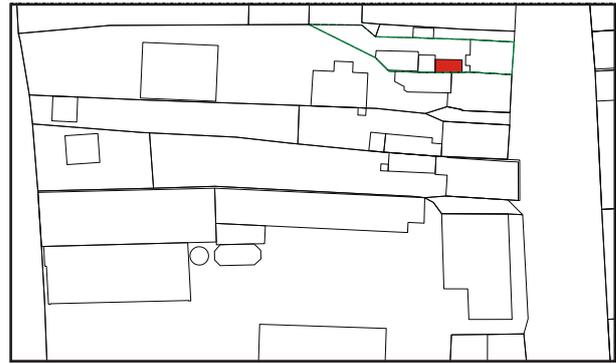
Lageplan aus dem Jahr 1964 (Ausschnitt) mit verkleinerter Parzelle und Darstellung der seinerzeit leerstehenden Scheune.
